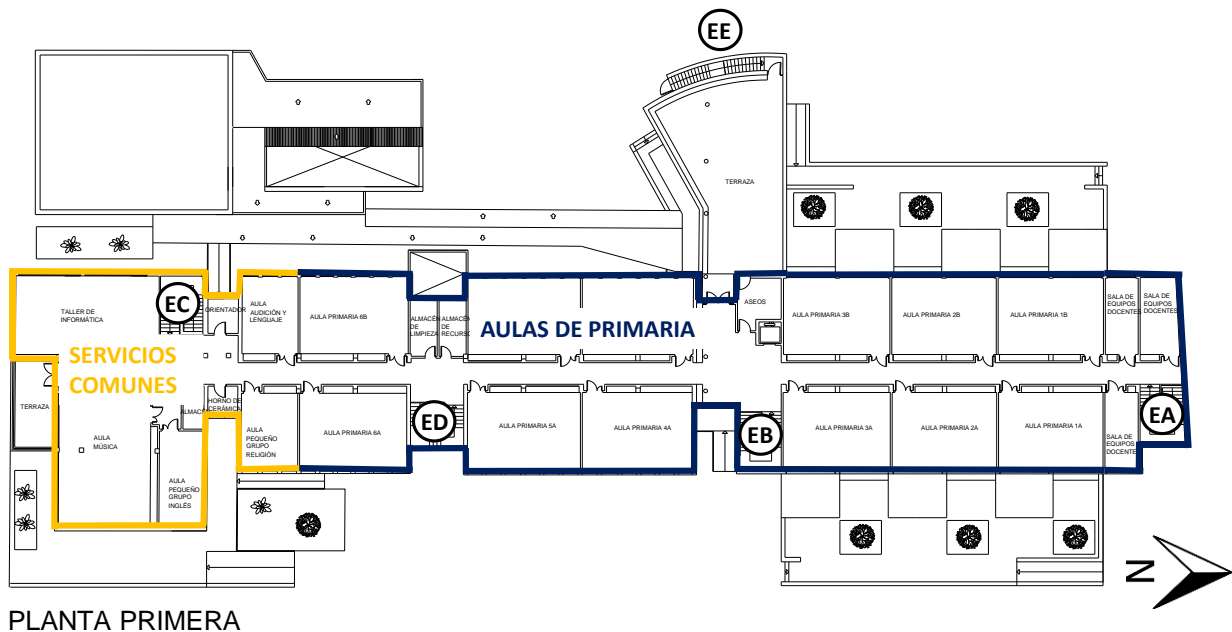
DISTRIBUCIÓN PLANTA PRIMERA
